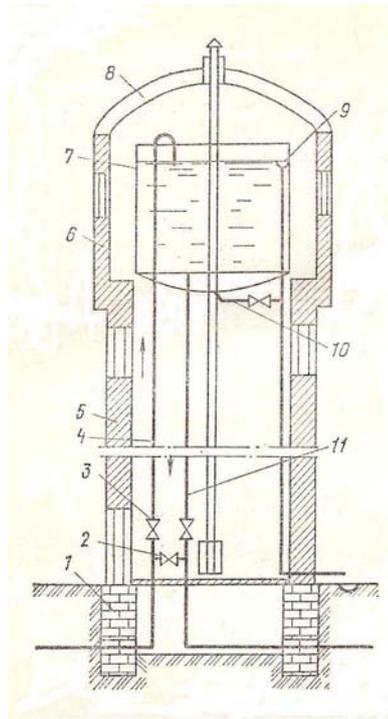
Схема водонапорной башни. 1 – фундамент; 2 – обратный клапан; 3 – задвижки; 4 – трубопровод подачи воды в бак; 5 – ствол башни; 6 – шатер; 7 – бак; 8 – кровля; 9 – перелив; 10 – трубопровод для опорожнения бака и удаления осадка; 11 – трубопровод подачи воды в водопроводную сеть.
